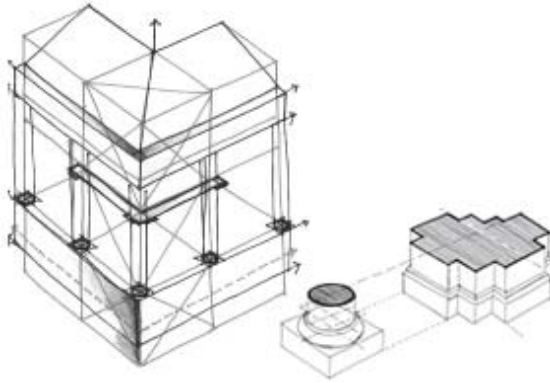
Edificio del Partenón. Análisis geométrico en planta y fachada.
